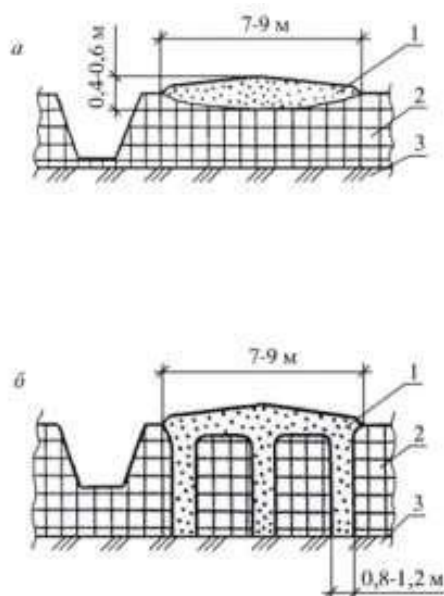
Грунтовые дороги на болотах[5]:
